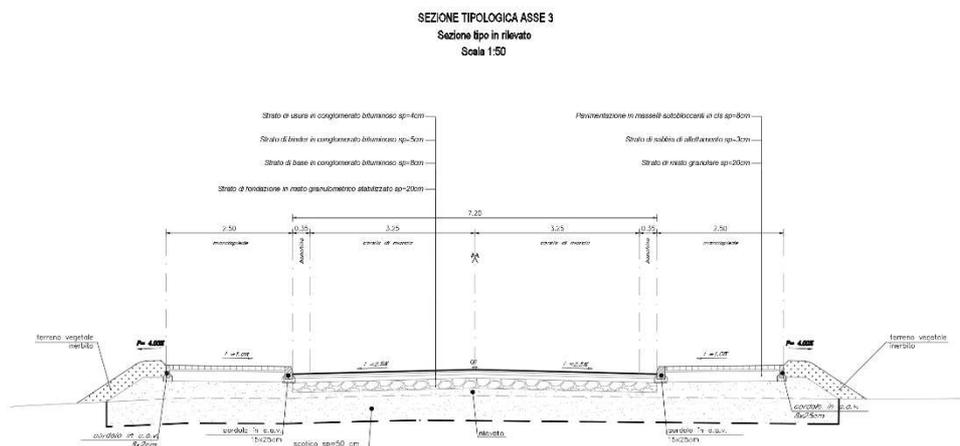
Sezione tipo in rilevato asse NV02A
